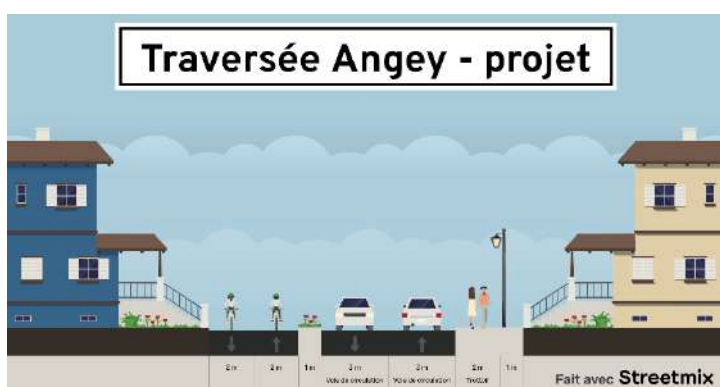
Plan coupe du projet de voie verte sur la traversée d'Angey avec 14 m de linéaire disponible.
